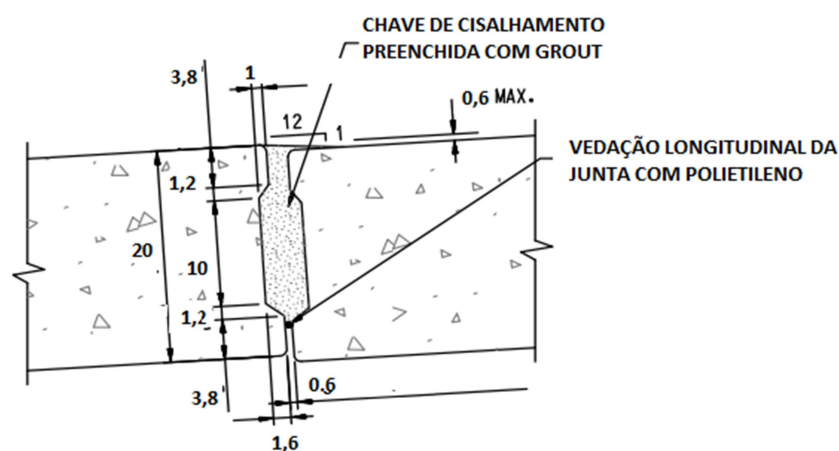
14: Conexão entre lajes pré-fabricadas de concreto com chave de cisalhamento.
